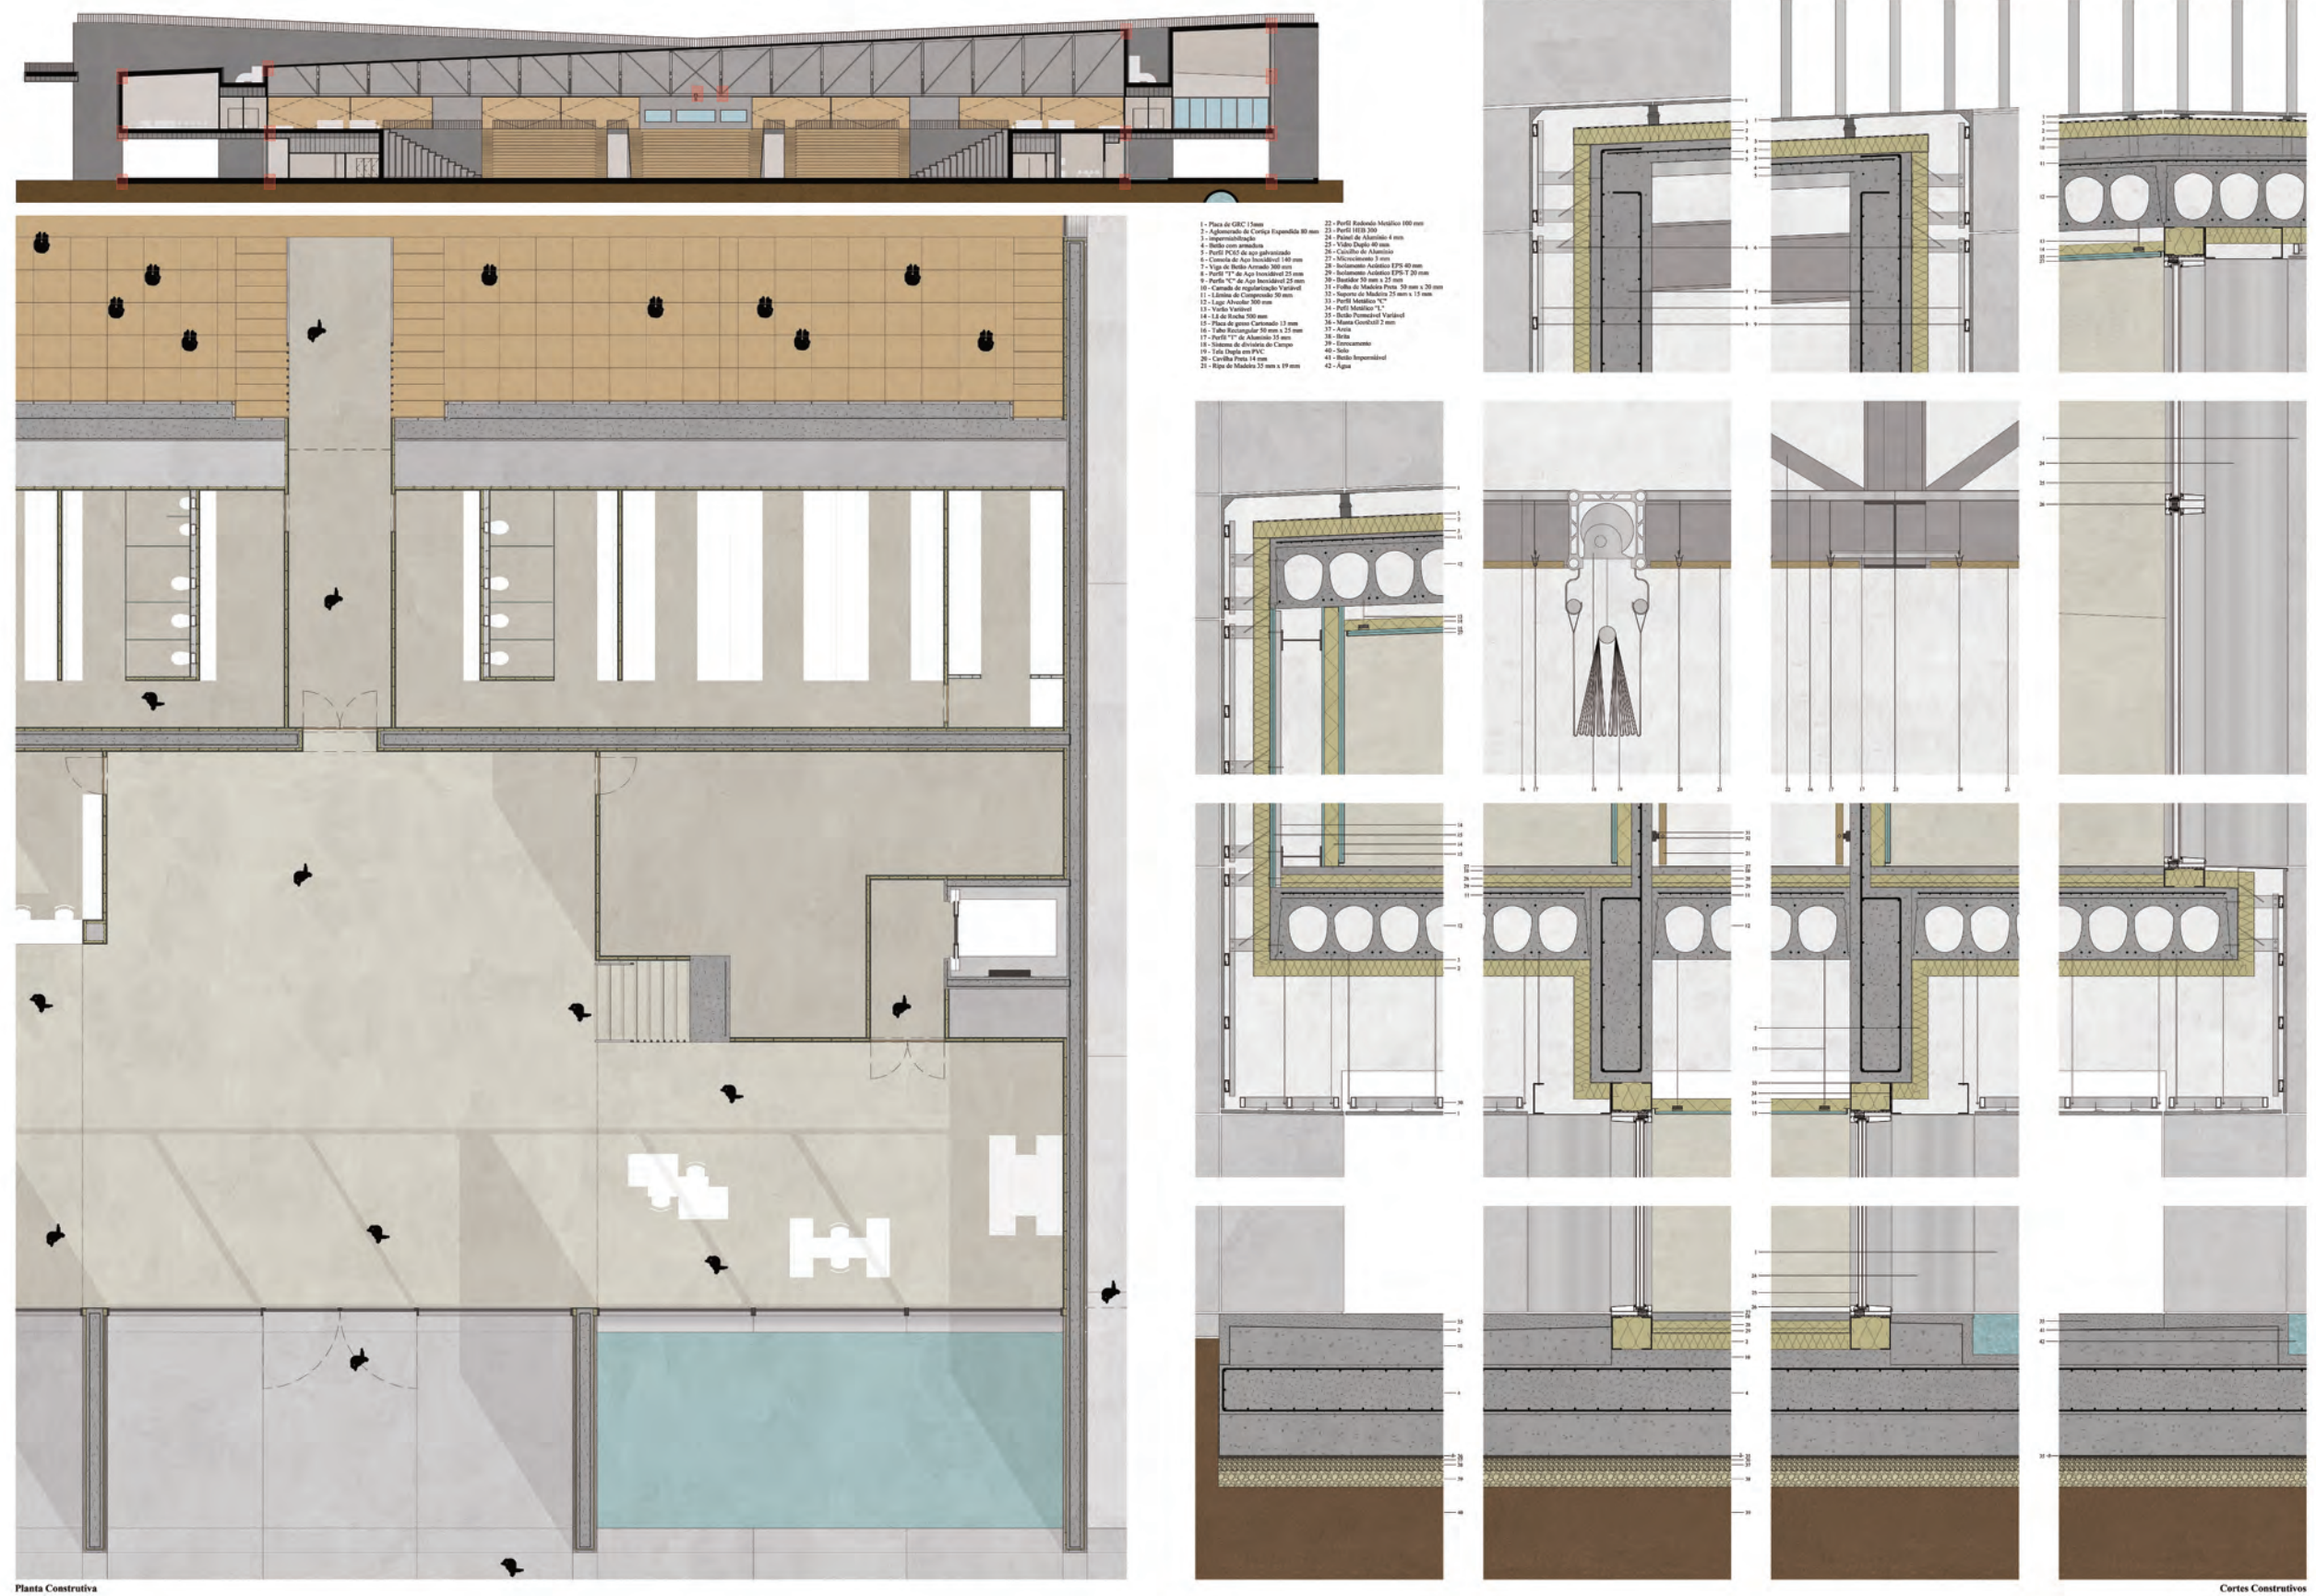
Paineis da planta de um setor e detalhes construtivos (ver painel A0 em anexo).
